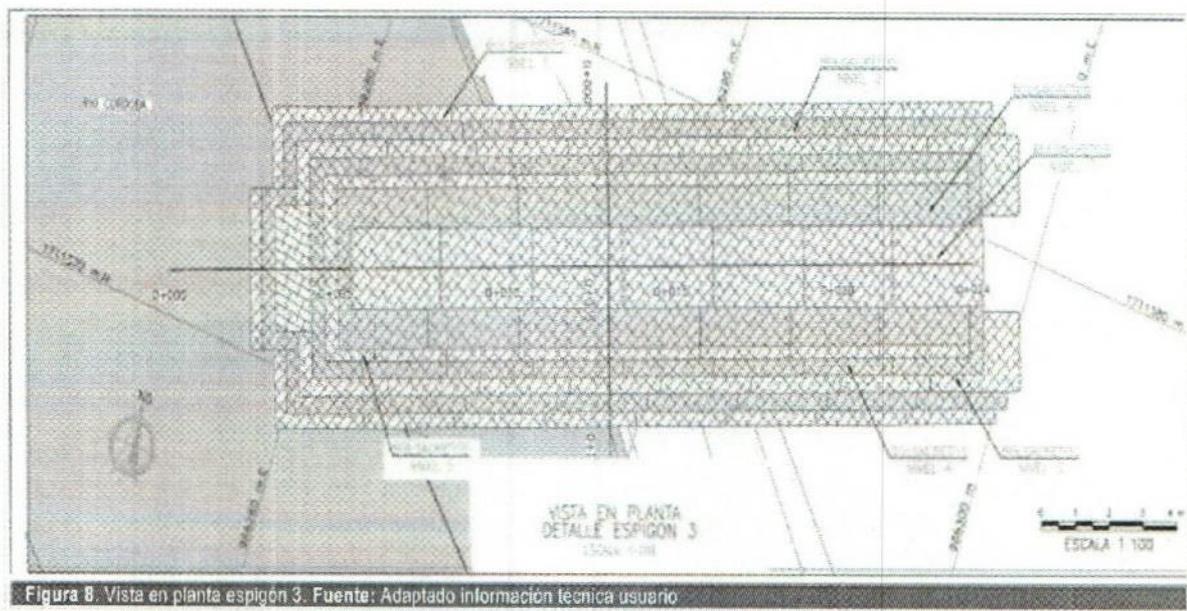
Vista en planta espigón 3. Fuente: Adaptado información técnica usuario
